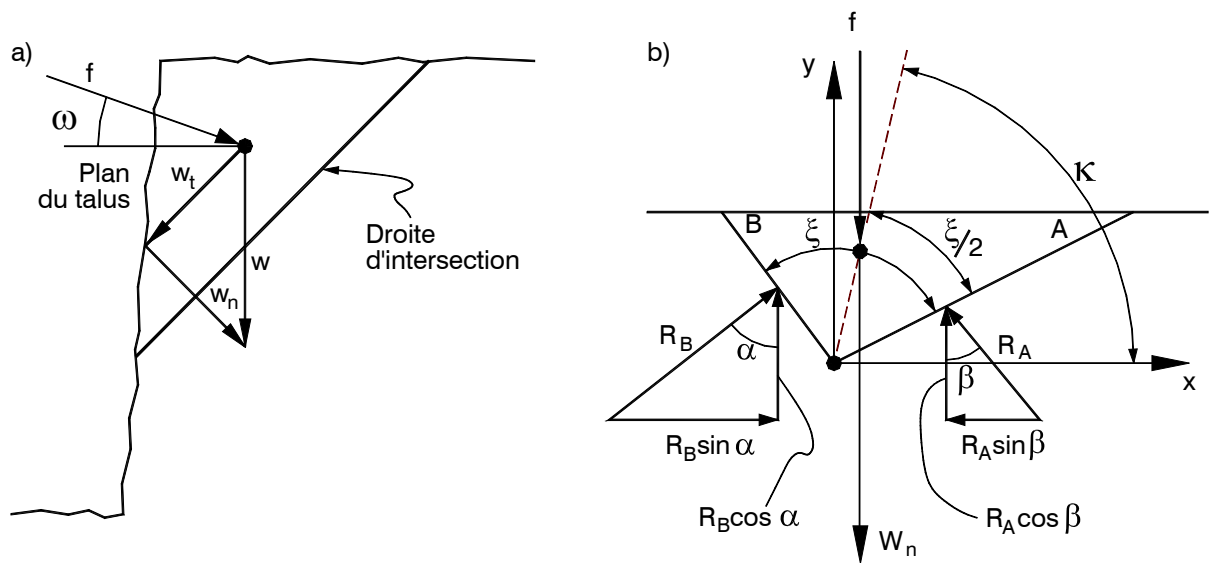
(a) : Section verticale contenant la droite d'intersection de deux plans de glissement (A et B) d'un tétraèdre de poids propre W découpé à la paroi d'une excavation au centre de gravité duquel agit une force f dirigée vers la droite d'intersection. (b) : Section normale à la droite d'intersection des deux plans de glissement, l'observateur faisant face à la paroi de l'excavation.
